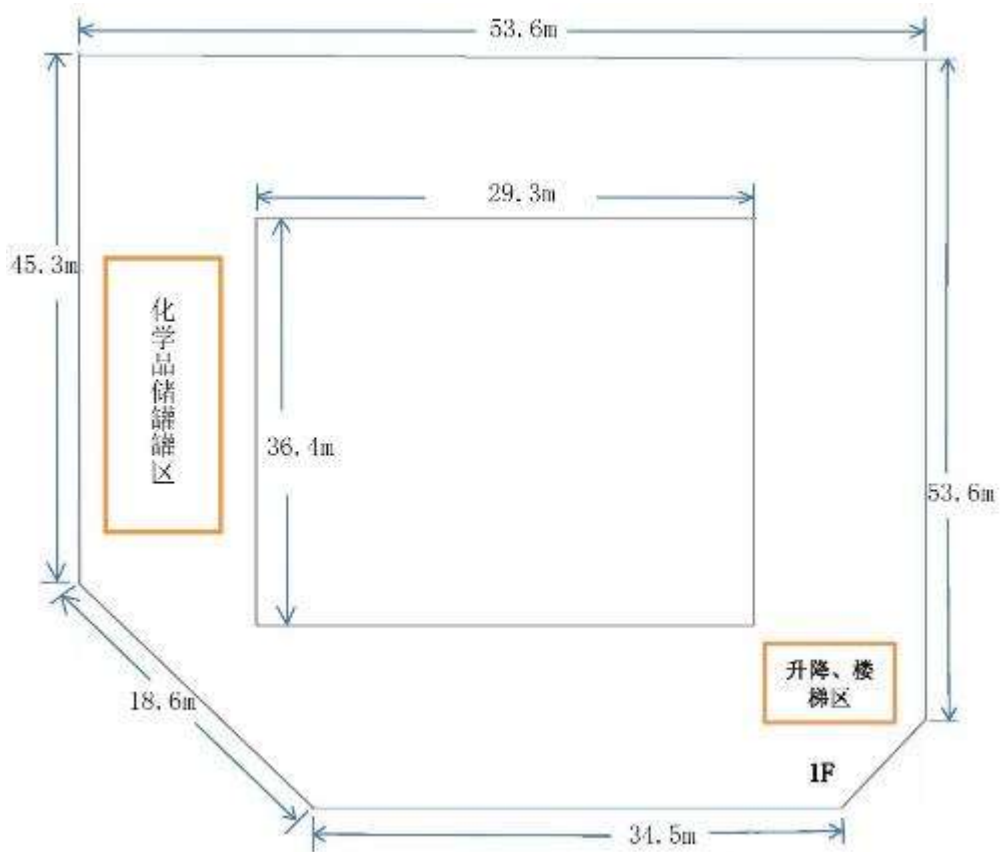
搬迁及改扩建后北厂区 2#厂房一层平面布置图
